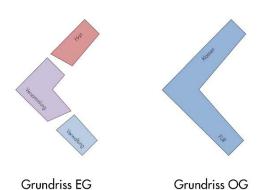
Piktografische Darstellung des Grundrisses
